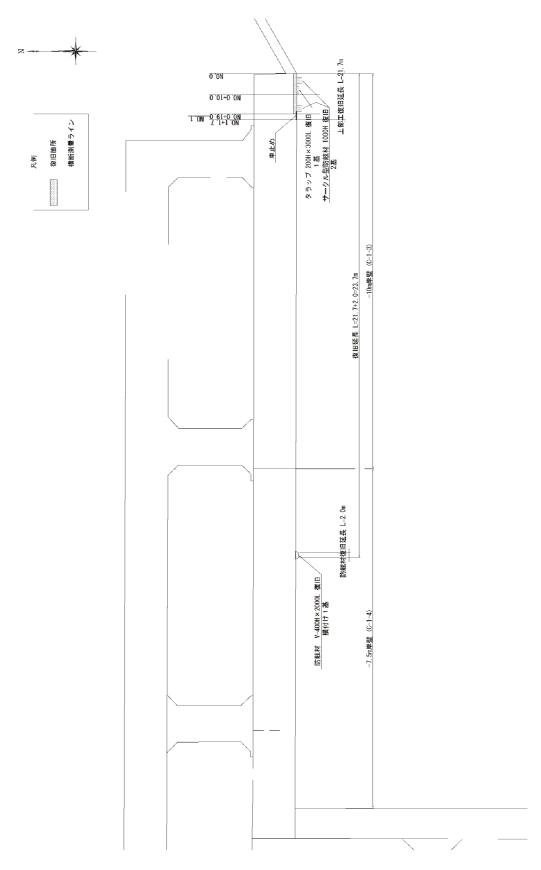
No.7 諏訪下-10m岸壁の平面図(復旧後)
